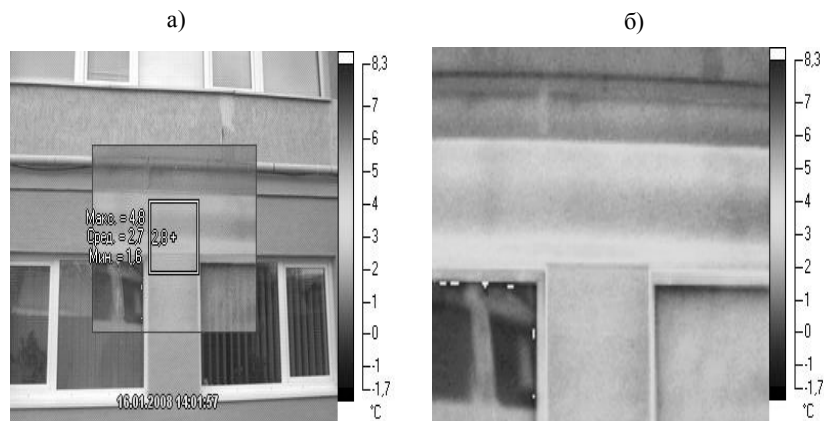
Утепление стен фасада здания ССТИ - минераловатные плиты:
